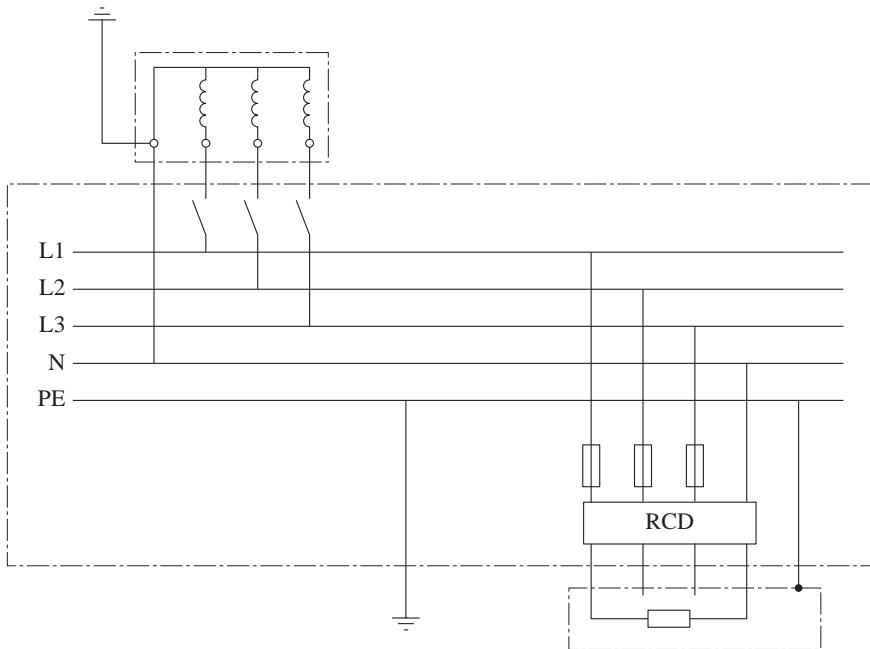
TT-System, Einfacheinspeisung
